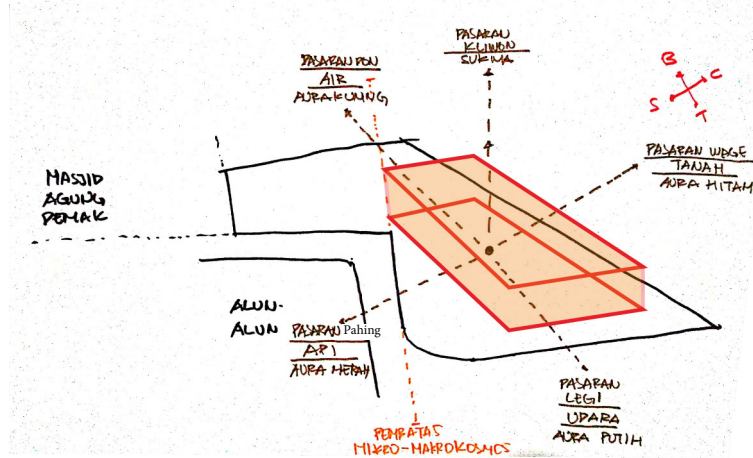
Eksplorasi Site Plan Tahap 1
